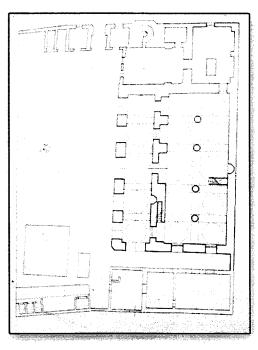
جامع تازا بالمغرب الأقصى (مسقط أفقي) عن: محمد الكحلاوي
